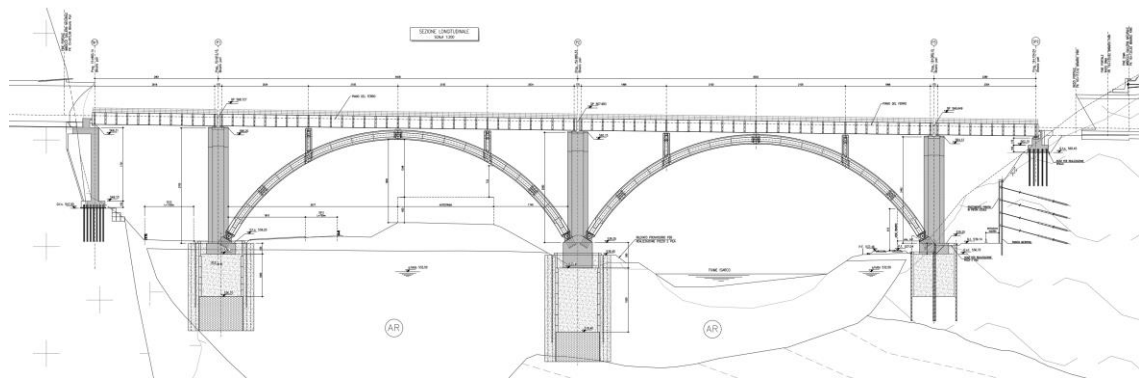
Profilo longitudinale del ponte sul binario pari
